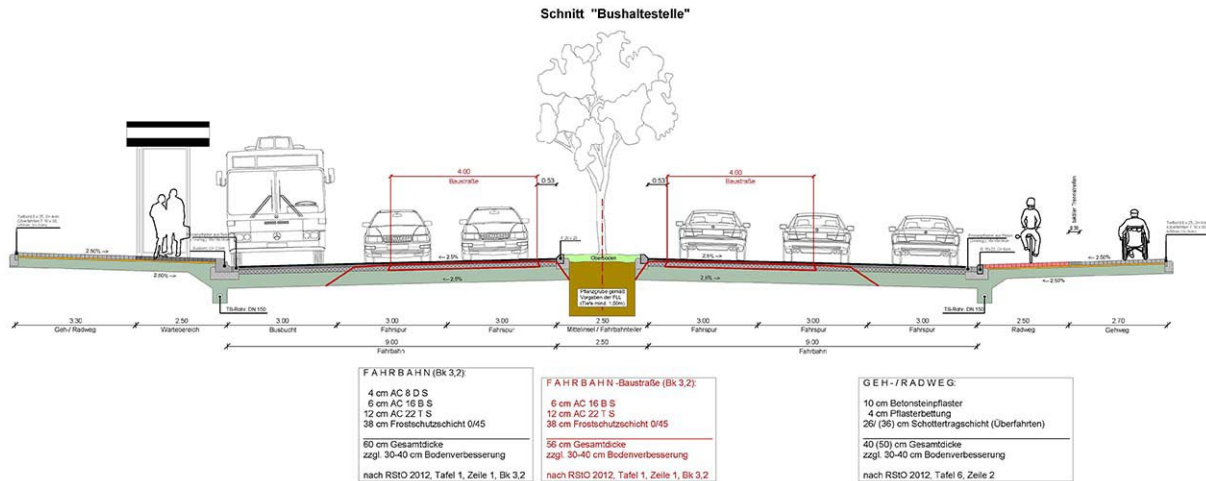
Straßenquerschnitt im Bereich der Bushaltestelle der Gottlieb-Daimler-Allee (Quelle: IMB Plan, Hanau)
